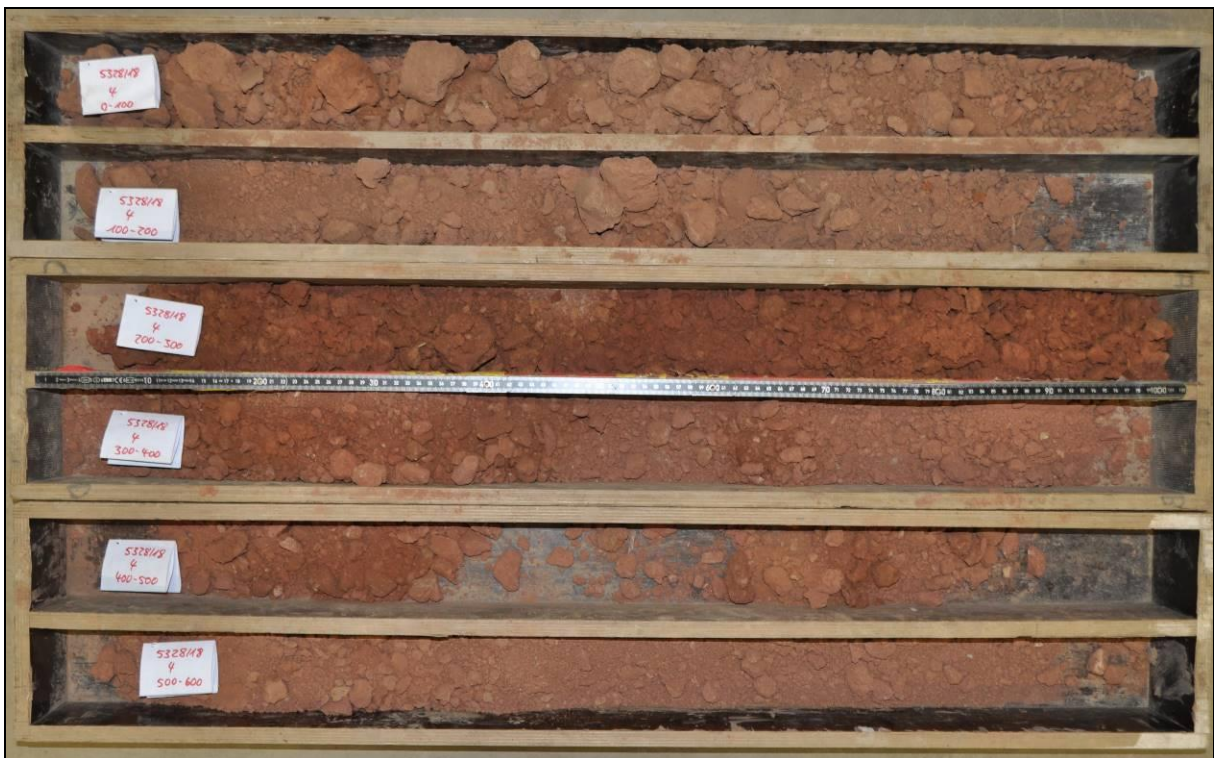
Erkundungsstelle 4 – Bohrgut Kleinrammbohrung
